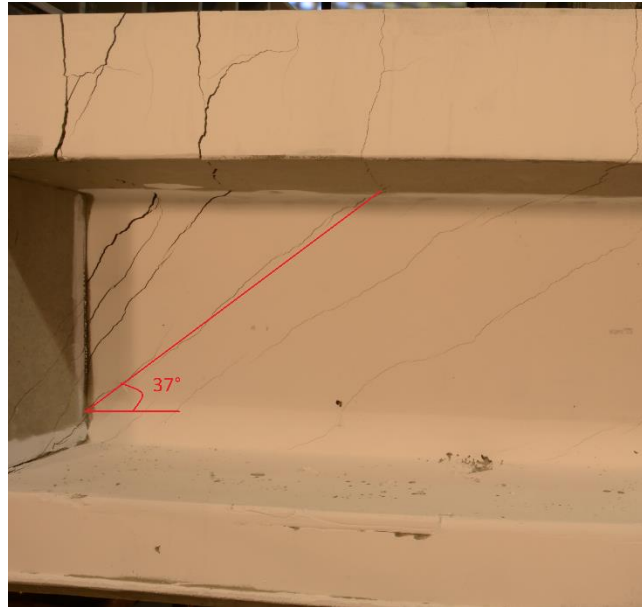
Ángulo de fisuración en la viga 3
